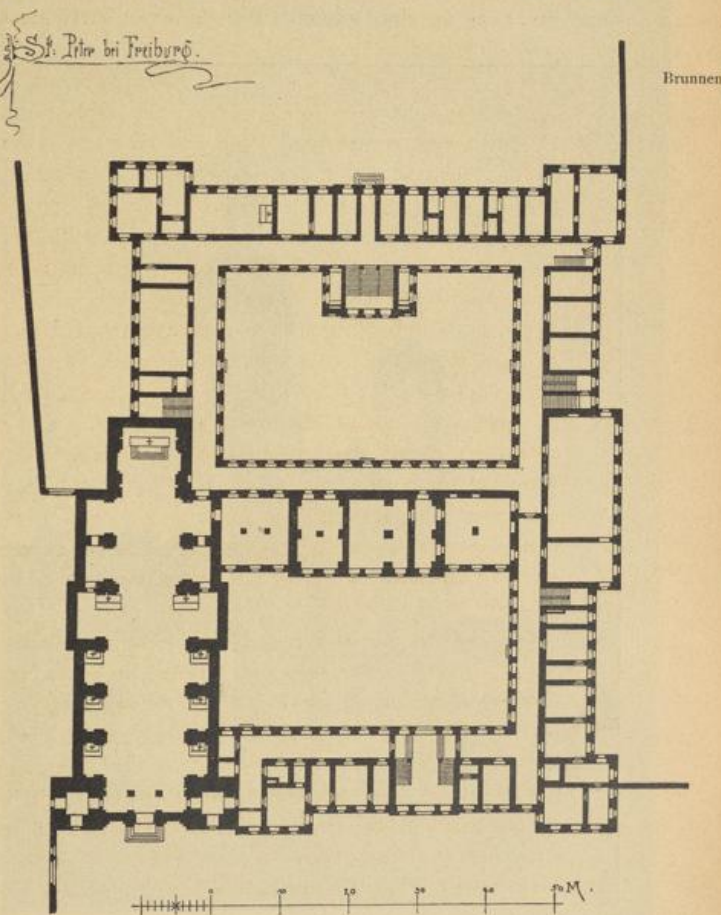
S. Peter. Grundriss der Klosteranlage.
